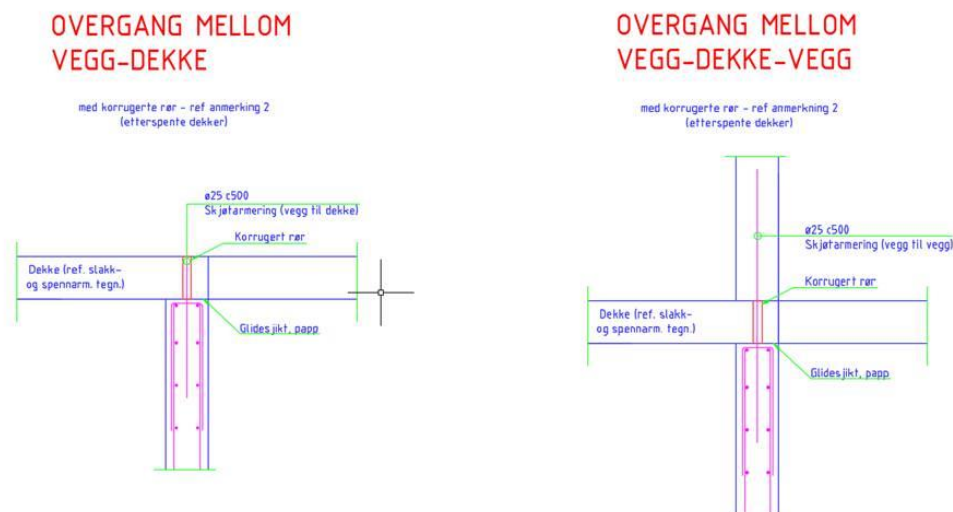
Eksempler på områder som krever tilleggsarmering
